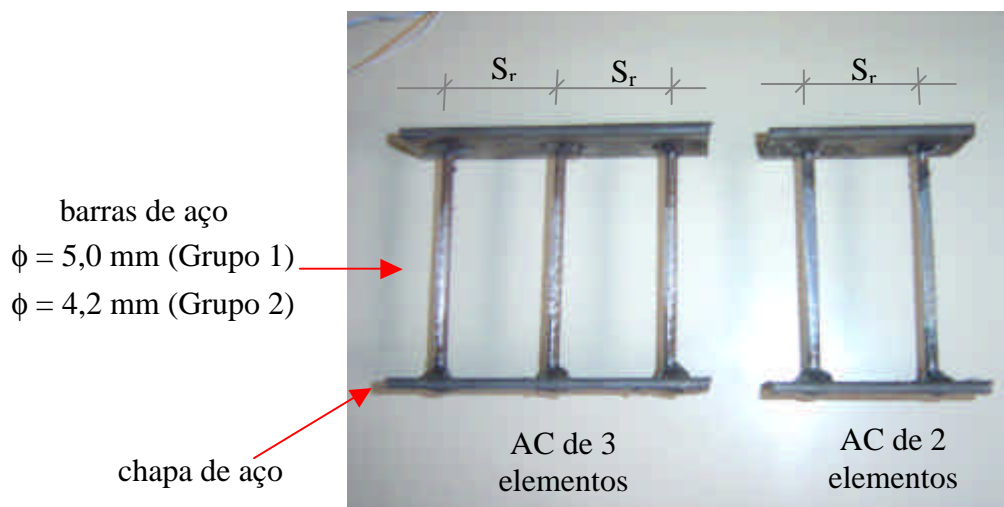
Armadura de cisalhamento do tipo *stud
